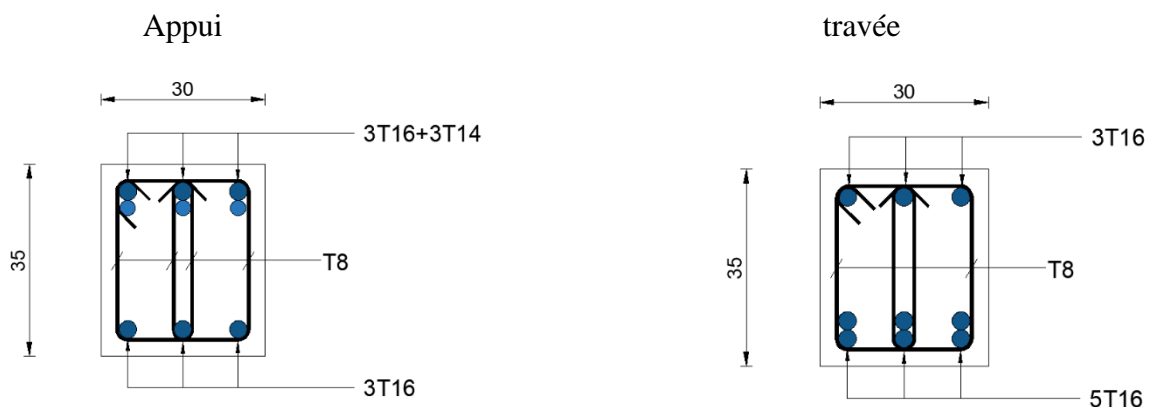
schéma de ferrailages des poutres porteuse (9^{ème} étage)
